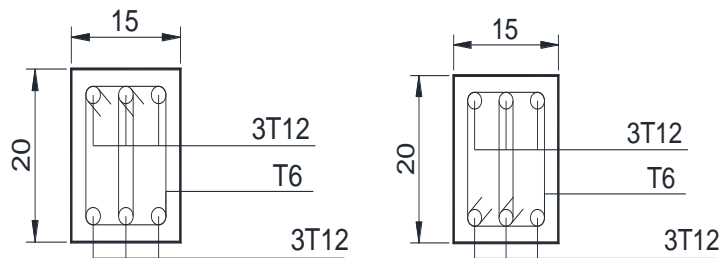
Coupe longitudinale d'une poutre noyée secondaire 15x20cm (bâtiment R+7)
